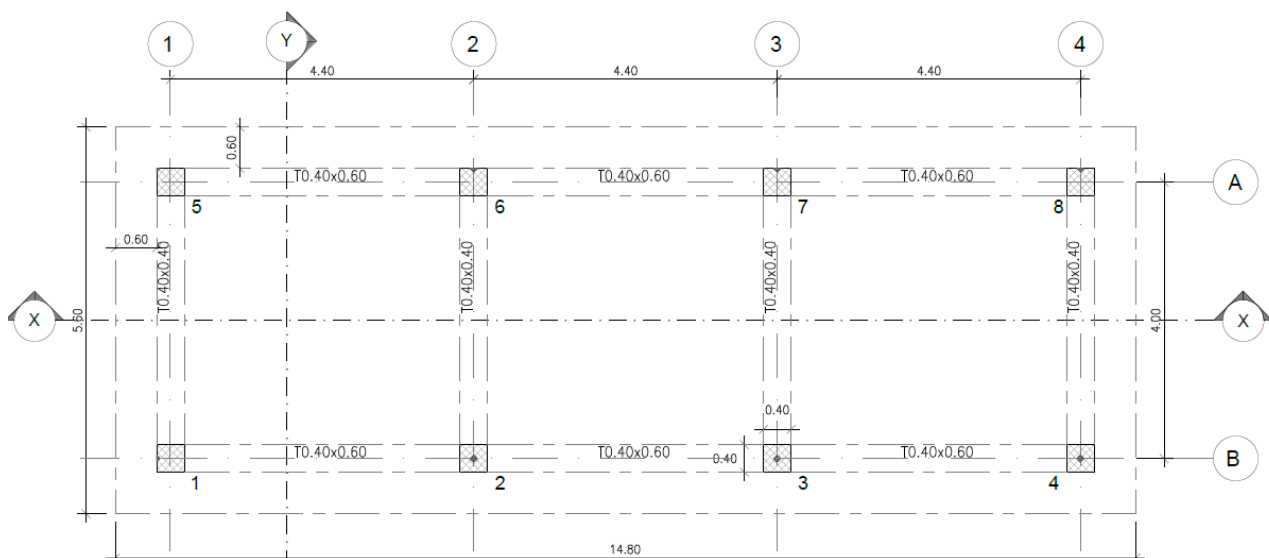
Struttura intelaiata del fabbricato in pianta
